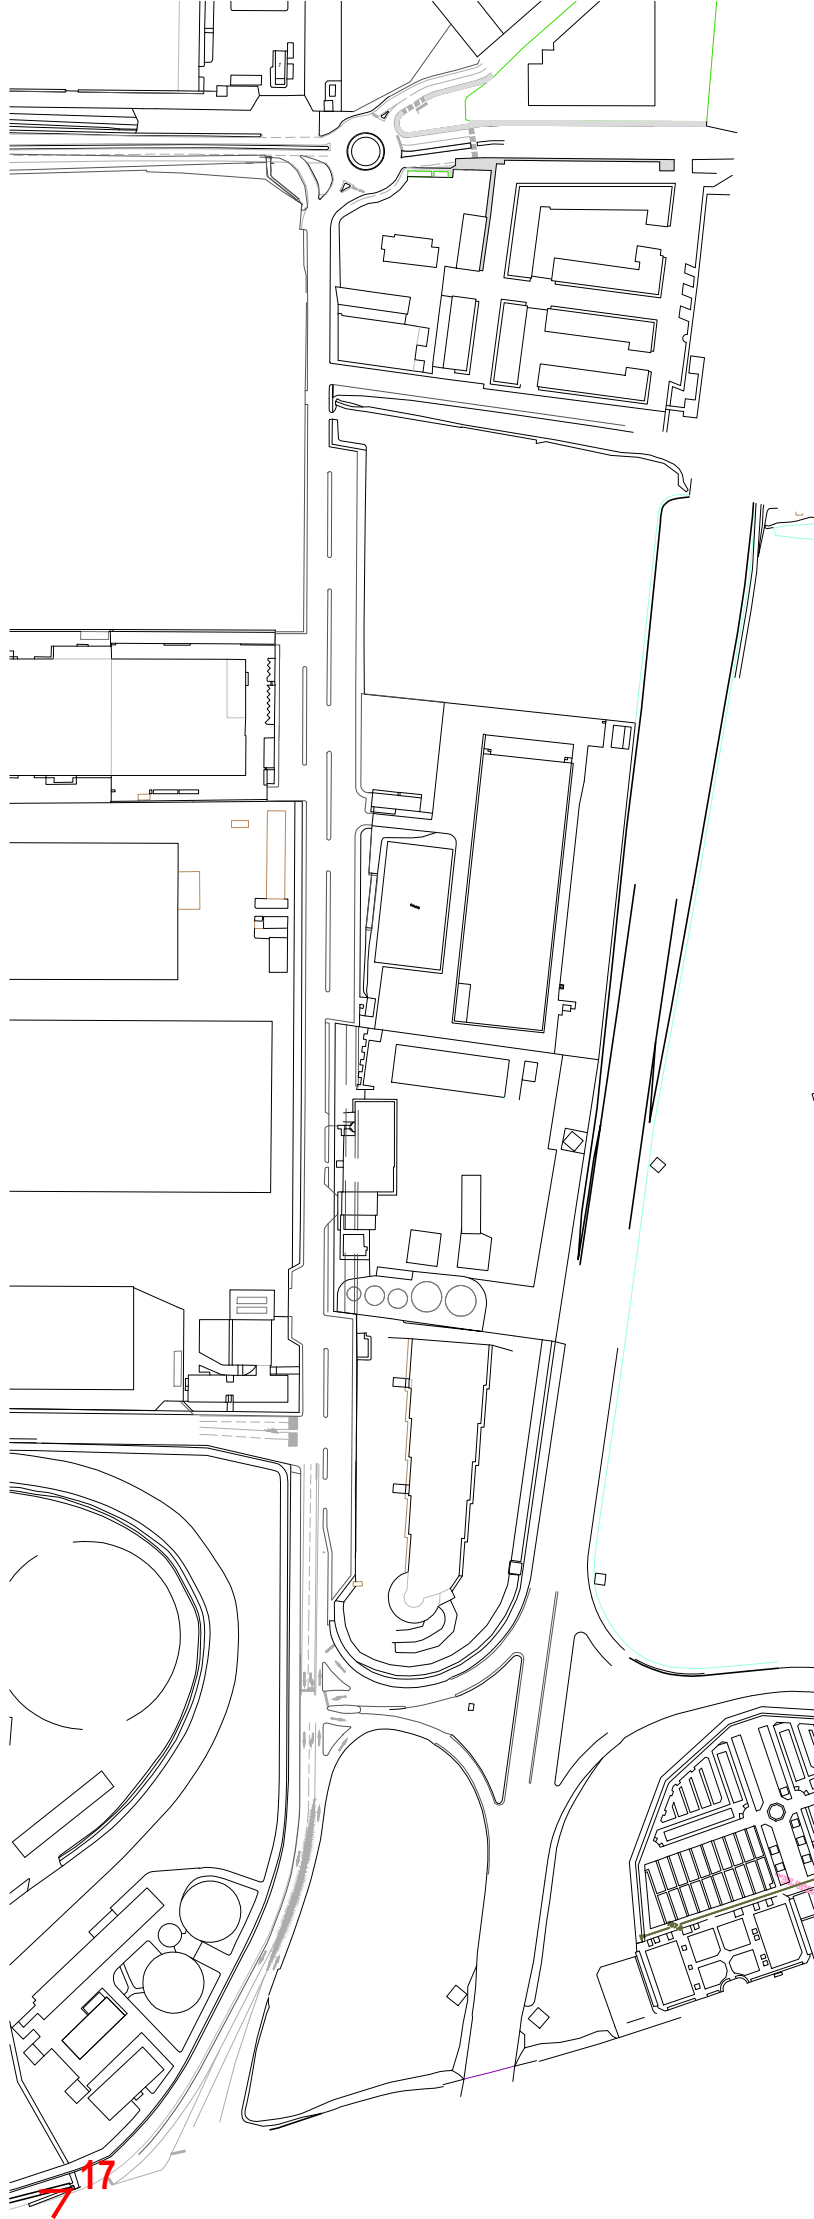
FOTO DELLO STATO DI FATTO E FOTOINSERIMENTO
